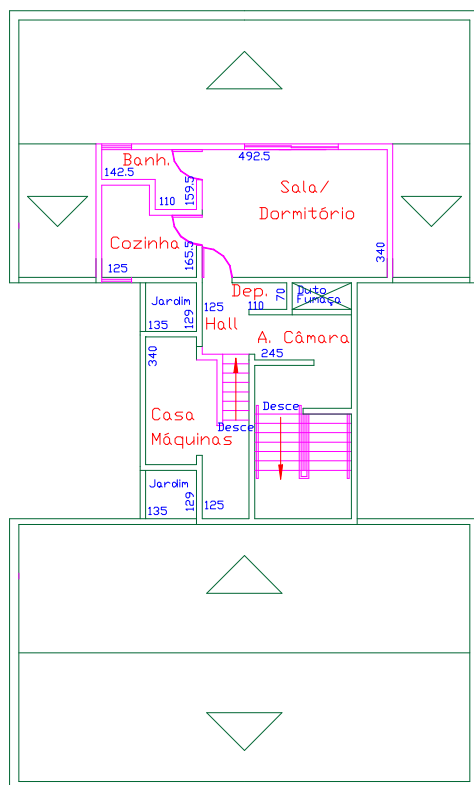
Edifício Exemplo: Planta Baixa Ático
